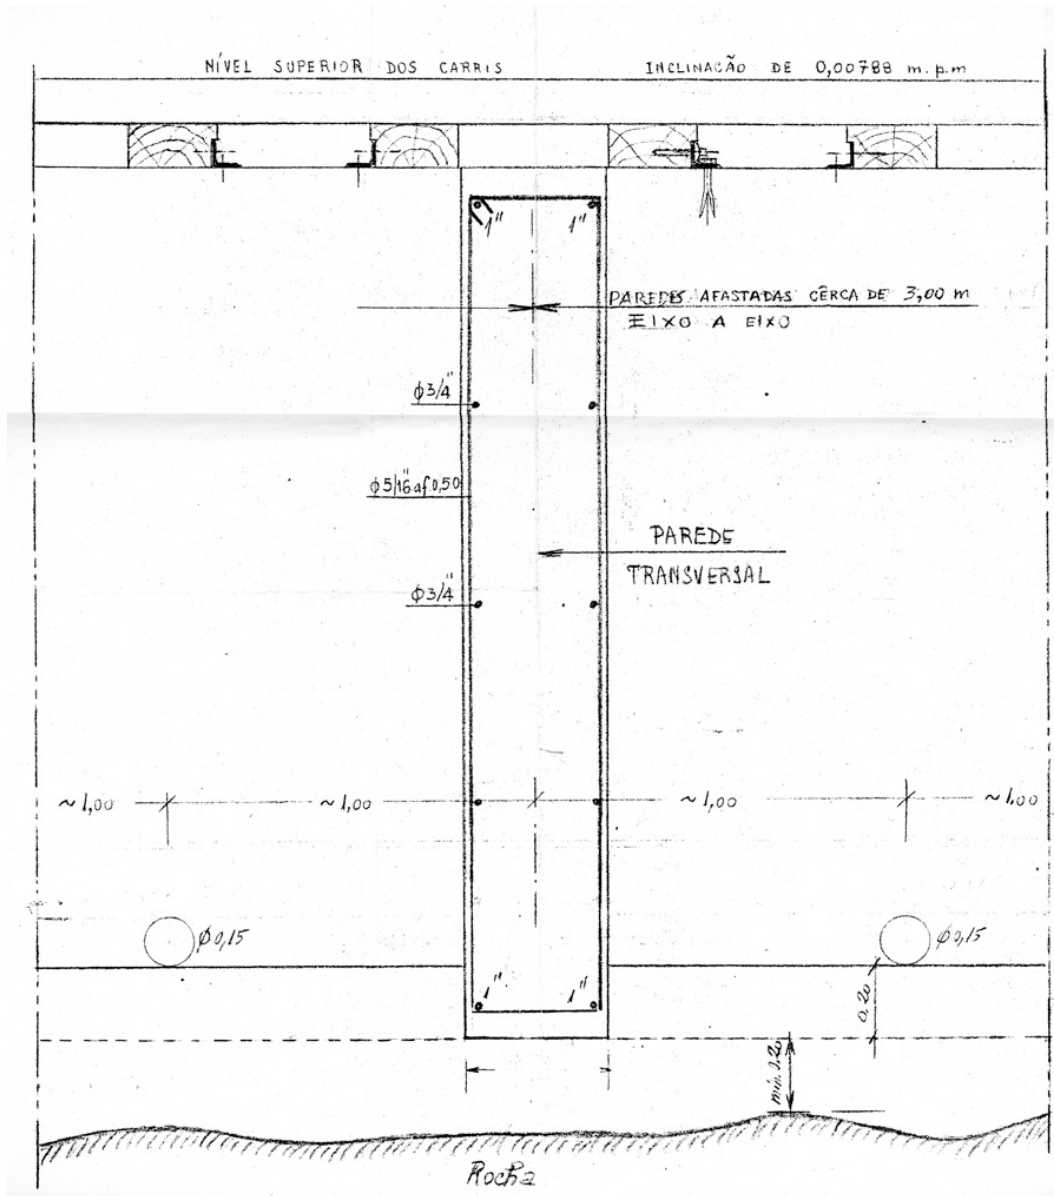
Viaduto das Fragas Más – estrutura de betão armado – parede transversal (fonte: REFER)
